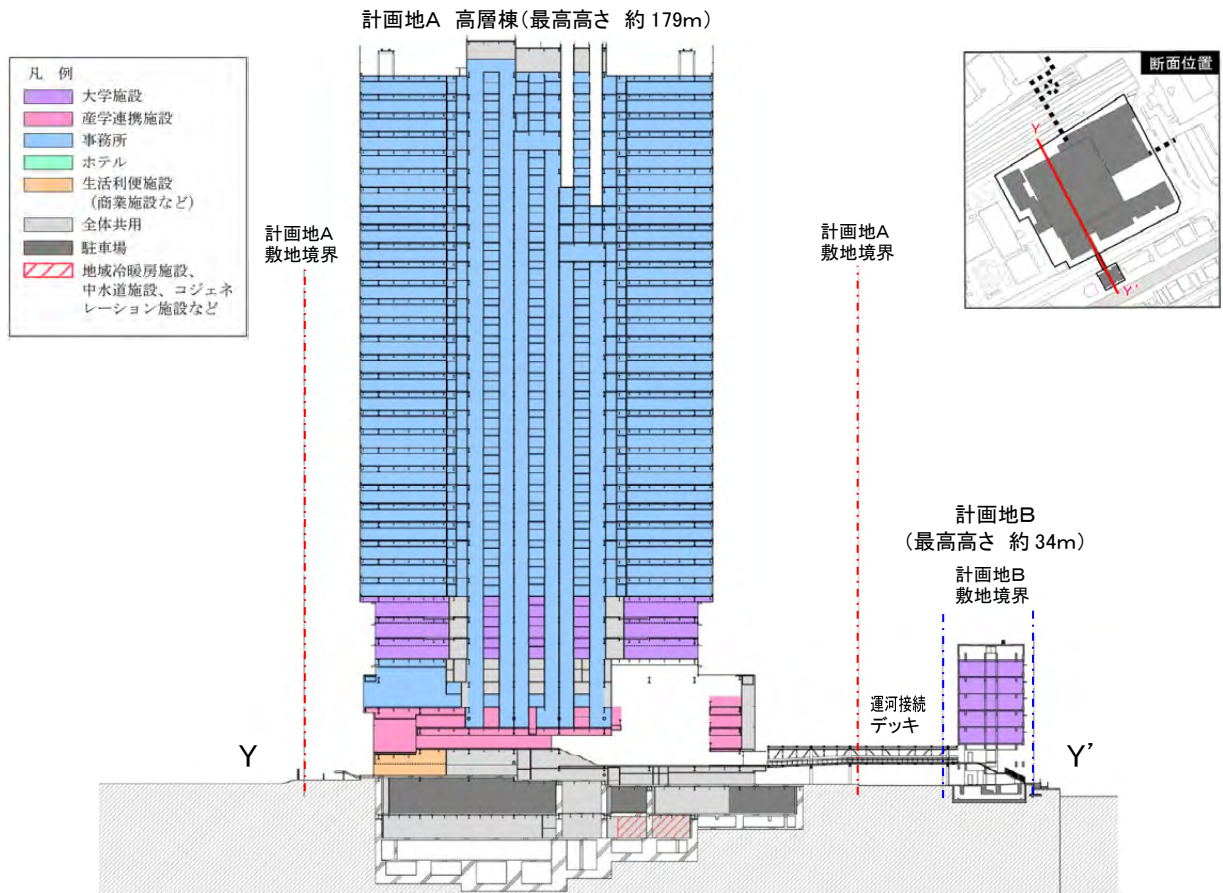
(2) 計画建築物断面図 (Y-Y' 断面) (S = 1 : 1,800)
